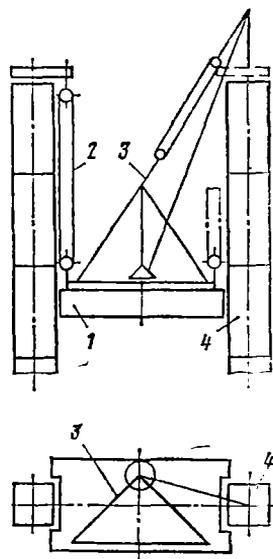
Схема монтажа деррик-крана на подъемной площадке:
